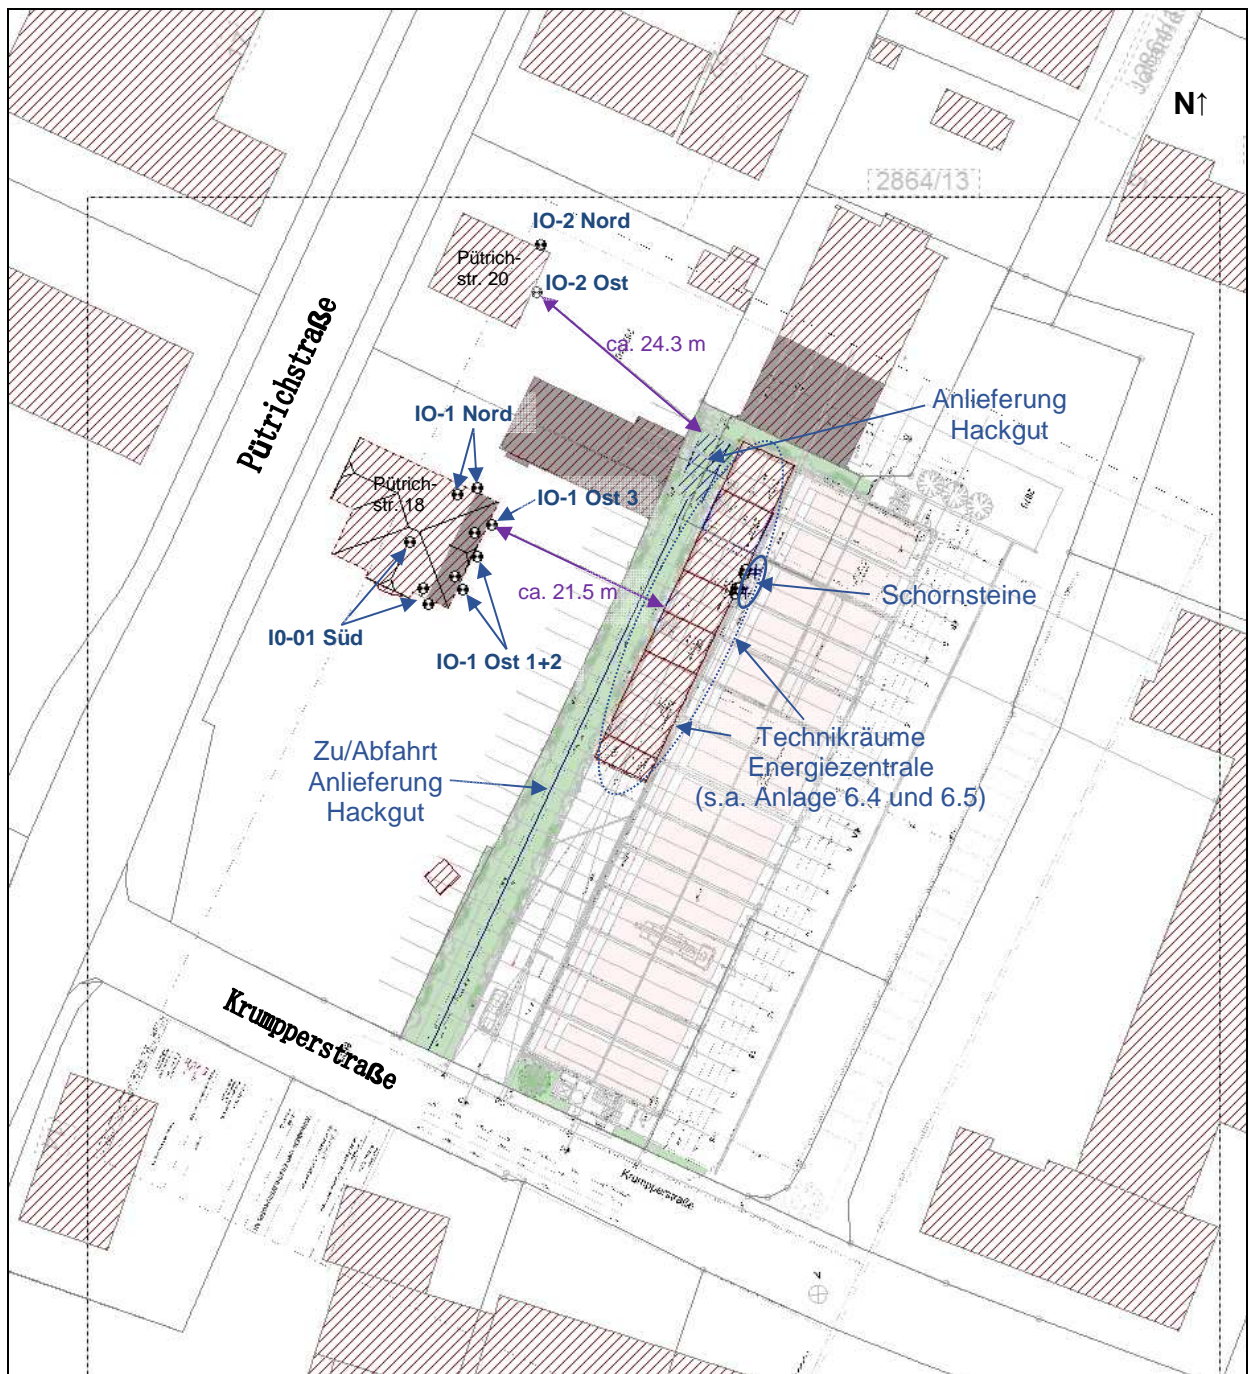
Lageplan, Vorhaben- und Erschließungsplan des vorhabenbezogenen Bebauungsplans „Parkhaus Krumpperstraße“ Stadt Weilheim i.OB [1]
